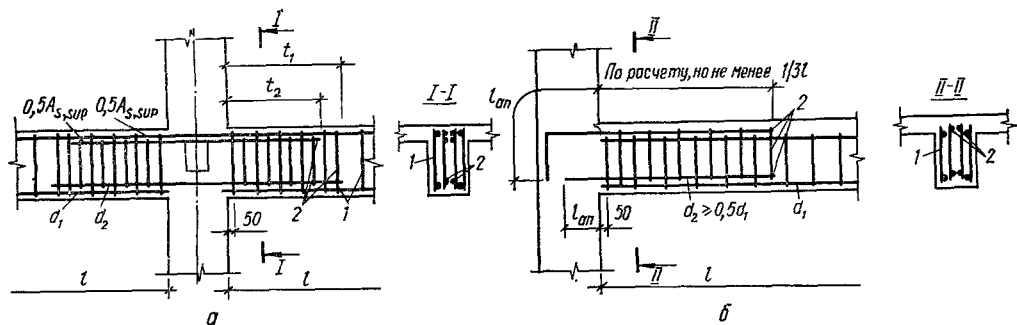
Армирование средних (а) и крайних (б) опор монолитных главных балок сварными сетками:
